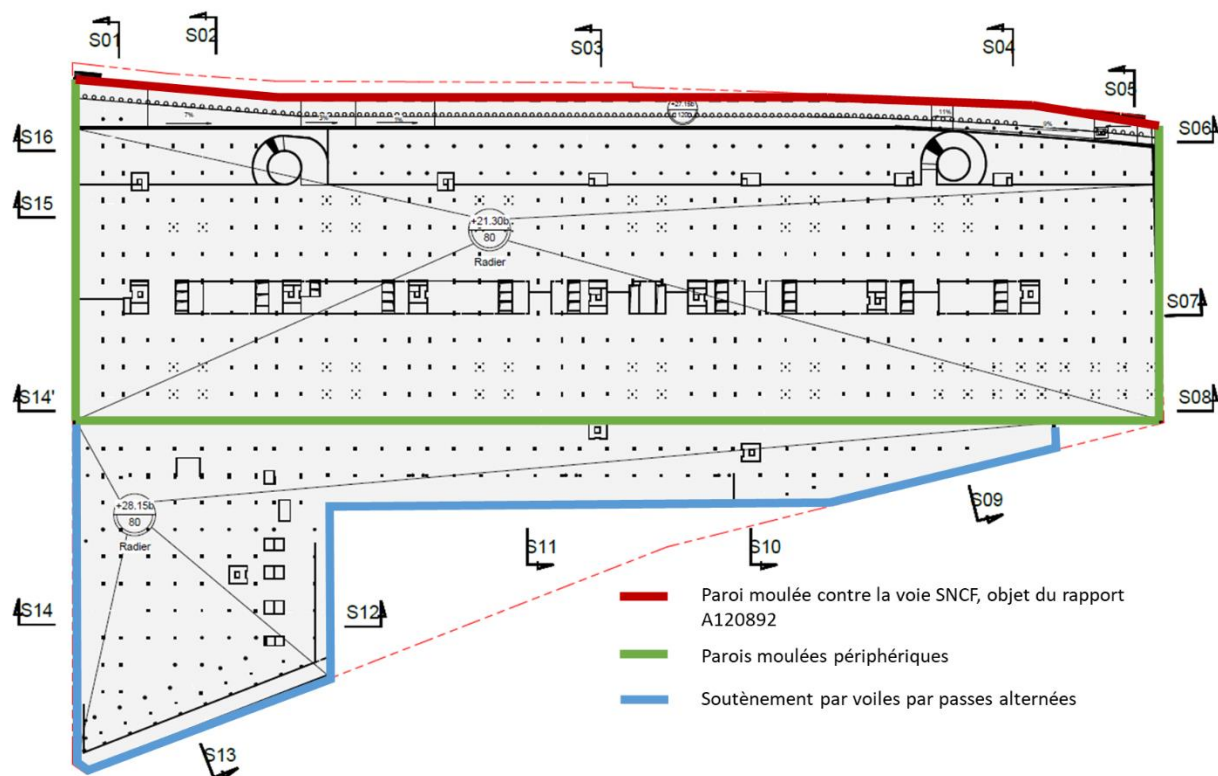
Extrait du plan de repérage des murs de soutènements, source : Ingérop
